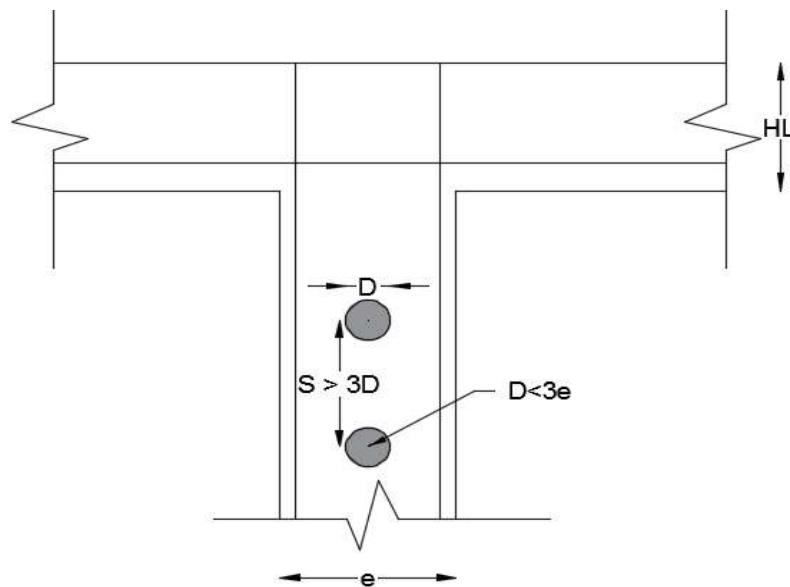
Disposiciones dadas en los Requisitos de Reglamento para concreto estructural ACI 318-08 para embeber tuberías y ductos en muros de concreto reforzado
